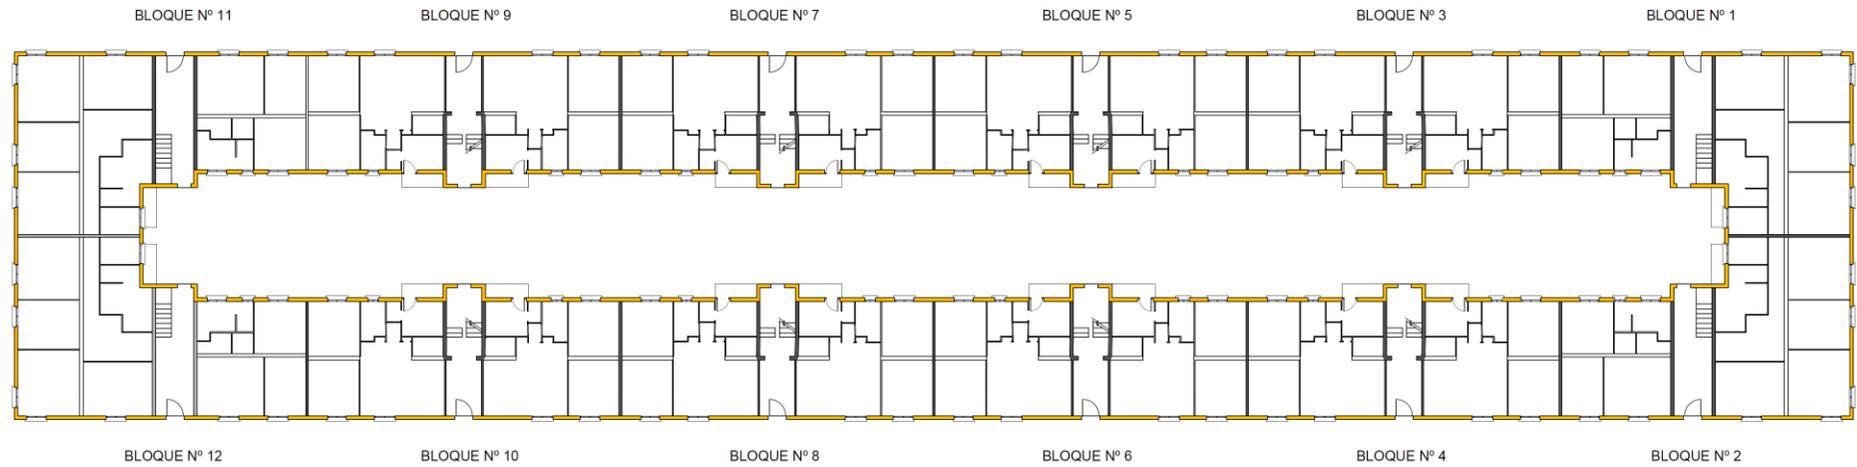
Sección en el bloque de edificios por la planta baja, amarillo la fachada y en negro la partición vivienda-vivienda.
